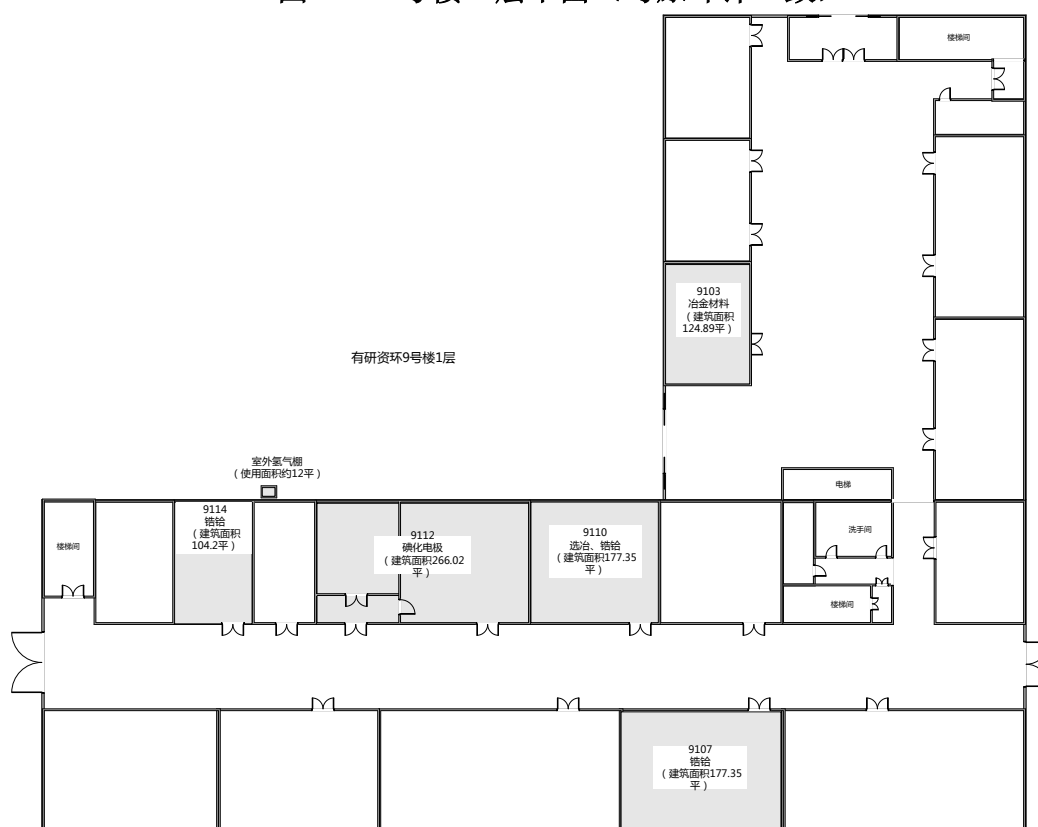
9 号楼一层平面图（一层的危废间调至四层）
